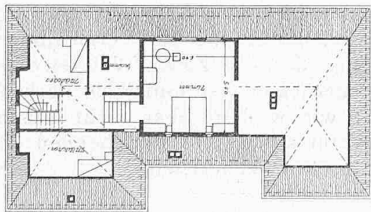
bis 5. Grundrisse vom Erdgeschoss, Ober- und Dachgeschoss, 1 : 400, des Landhauses Verbanello in Minusio bei Locarno. — Architekten Pestalozzi & Schucan, Zürich.
